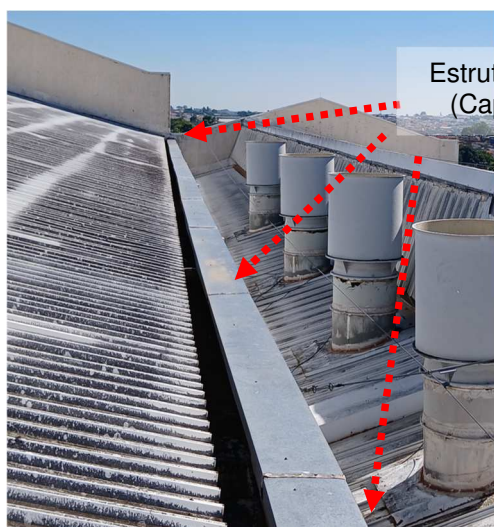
e 143: Malha captora construída em perfil de alumínio seção #70mm².
